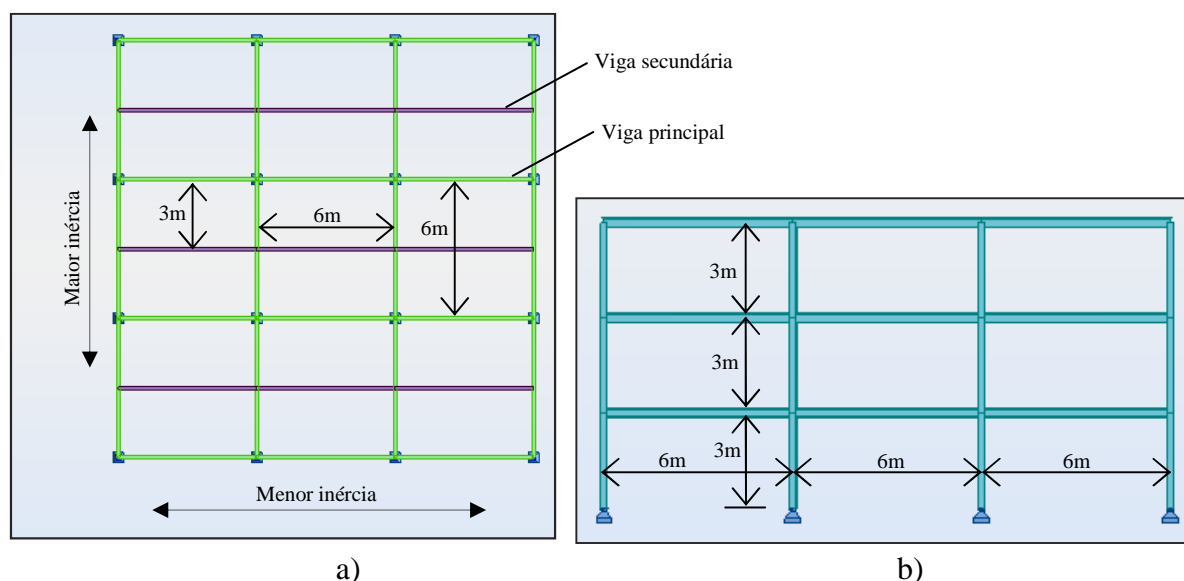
Solução estrutural adotada: a) vista em planta b) vista em alçado.
